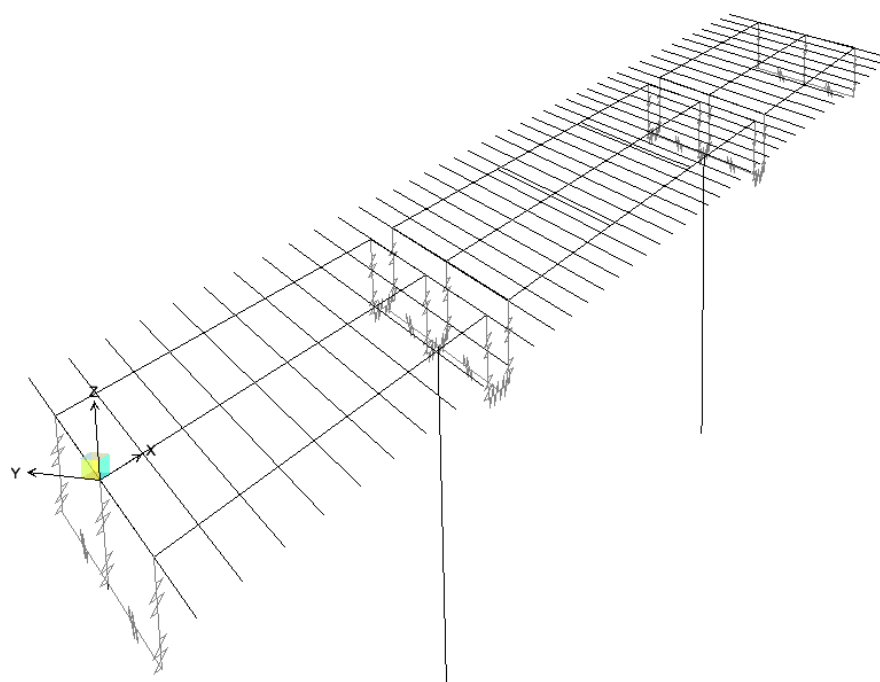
Modello di calcolo: con elementi shell soletta non in vista
